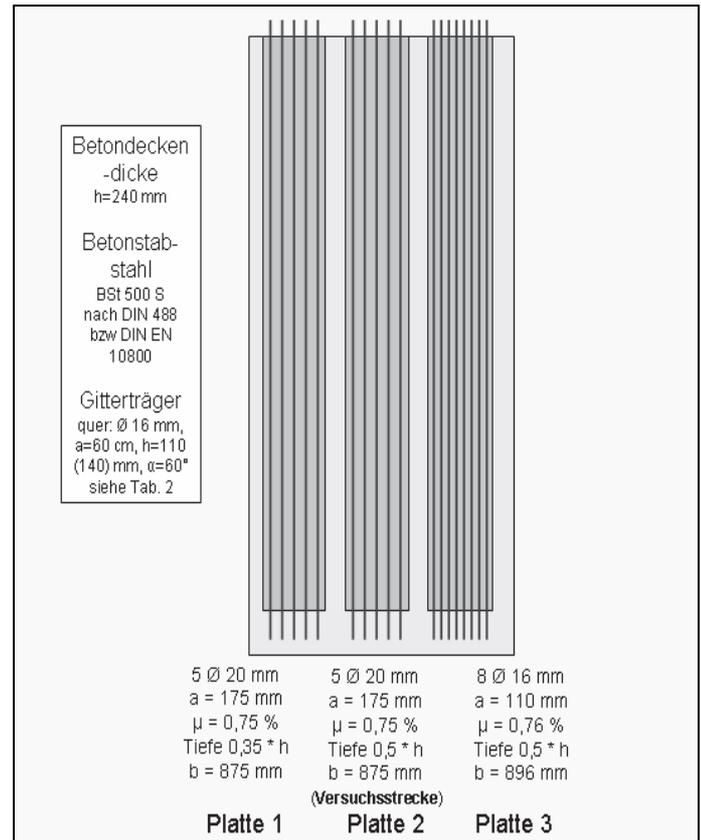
Längsbewehrung der drei durchgehend bewehrten Betonplattenstreifen im Großprüfstand
